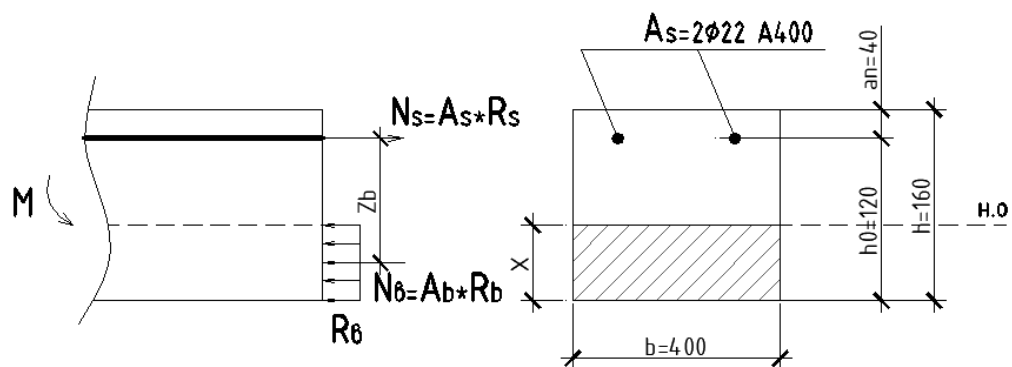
Схема внутренних усилий главной балки Г.б-2 на опоре
